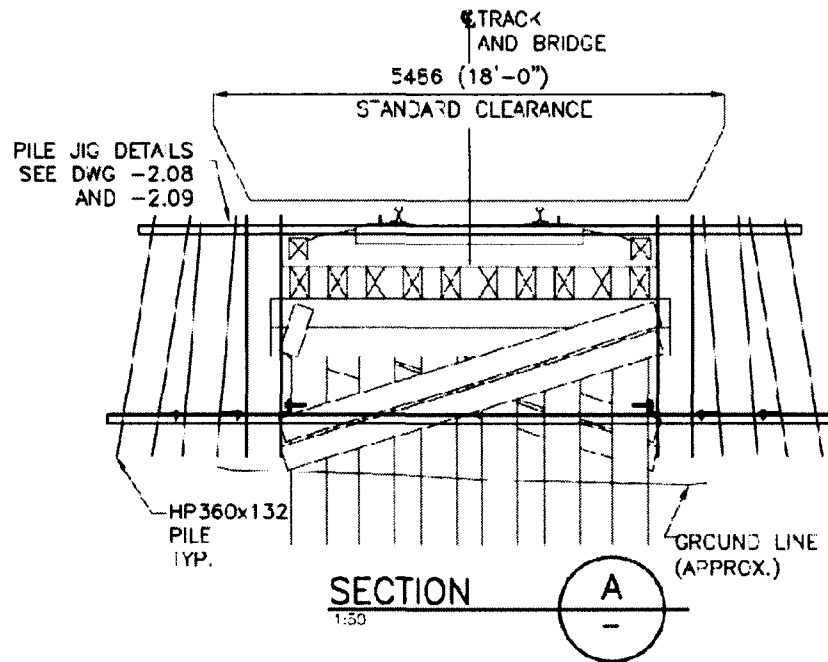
Section transversale d'un pont en bois du CN [CN AA663-116.00-2.01]
